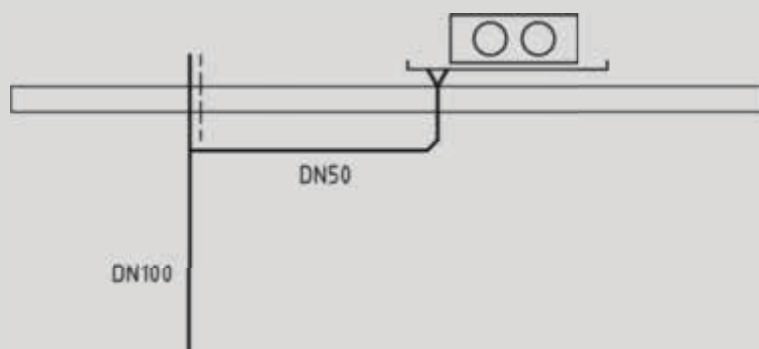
Dachablauf einer Auffangfläche mit senkrecht abgehendem Anschluss DN 50 an eine Schmutzwasserfalleitung DN 100
